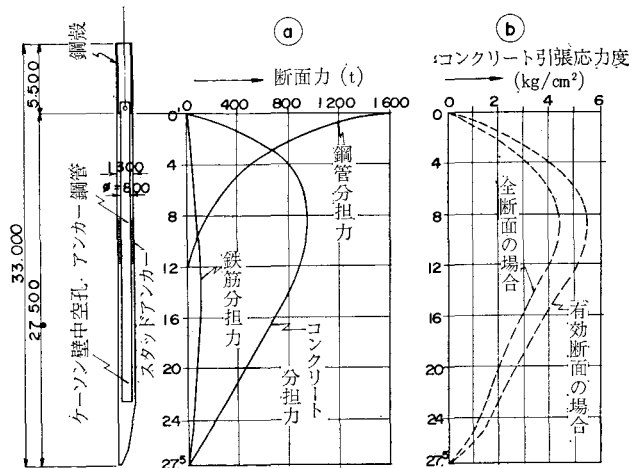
ケーソンを吊り上げ時の断面力とコンクリート引張応力度
